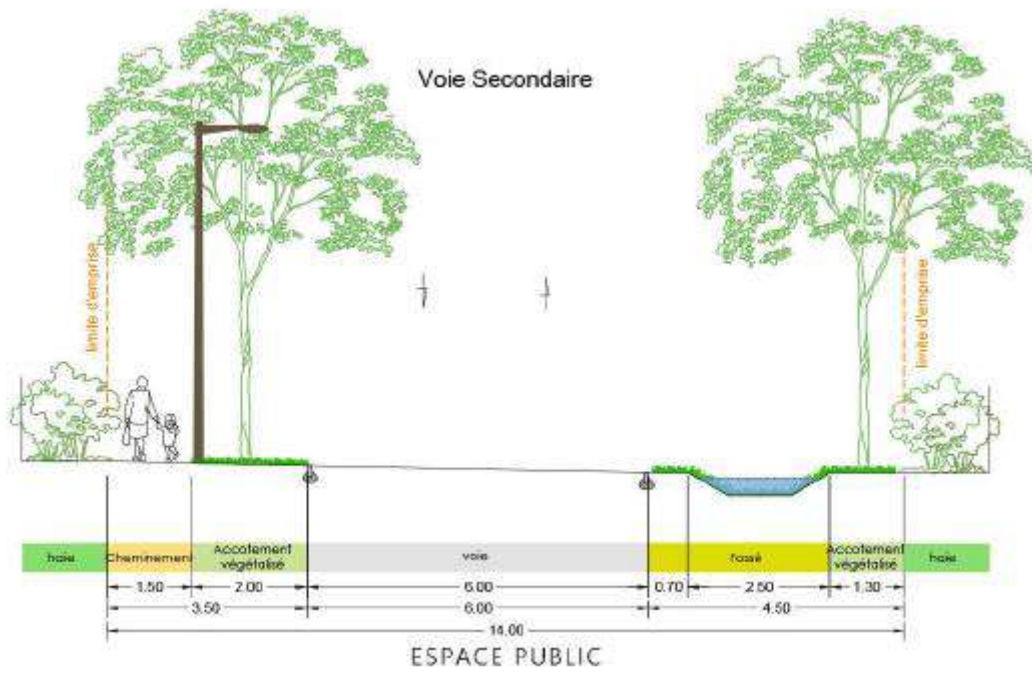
Plan en coupe d'une voie secondaire (Source : VERDI)
